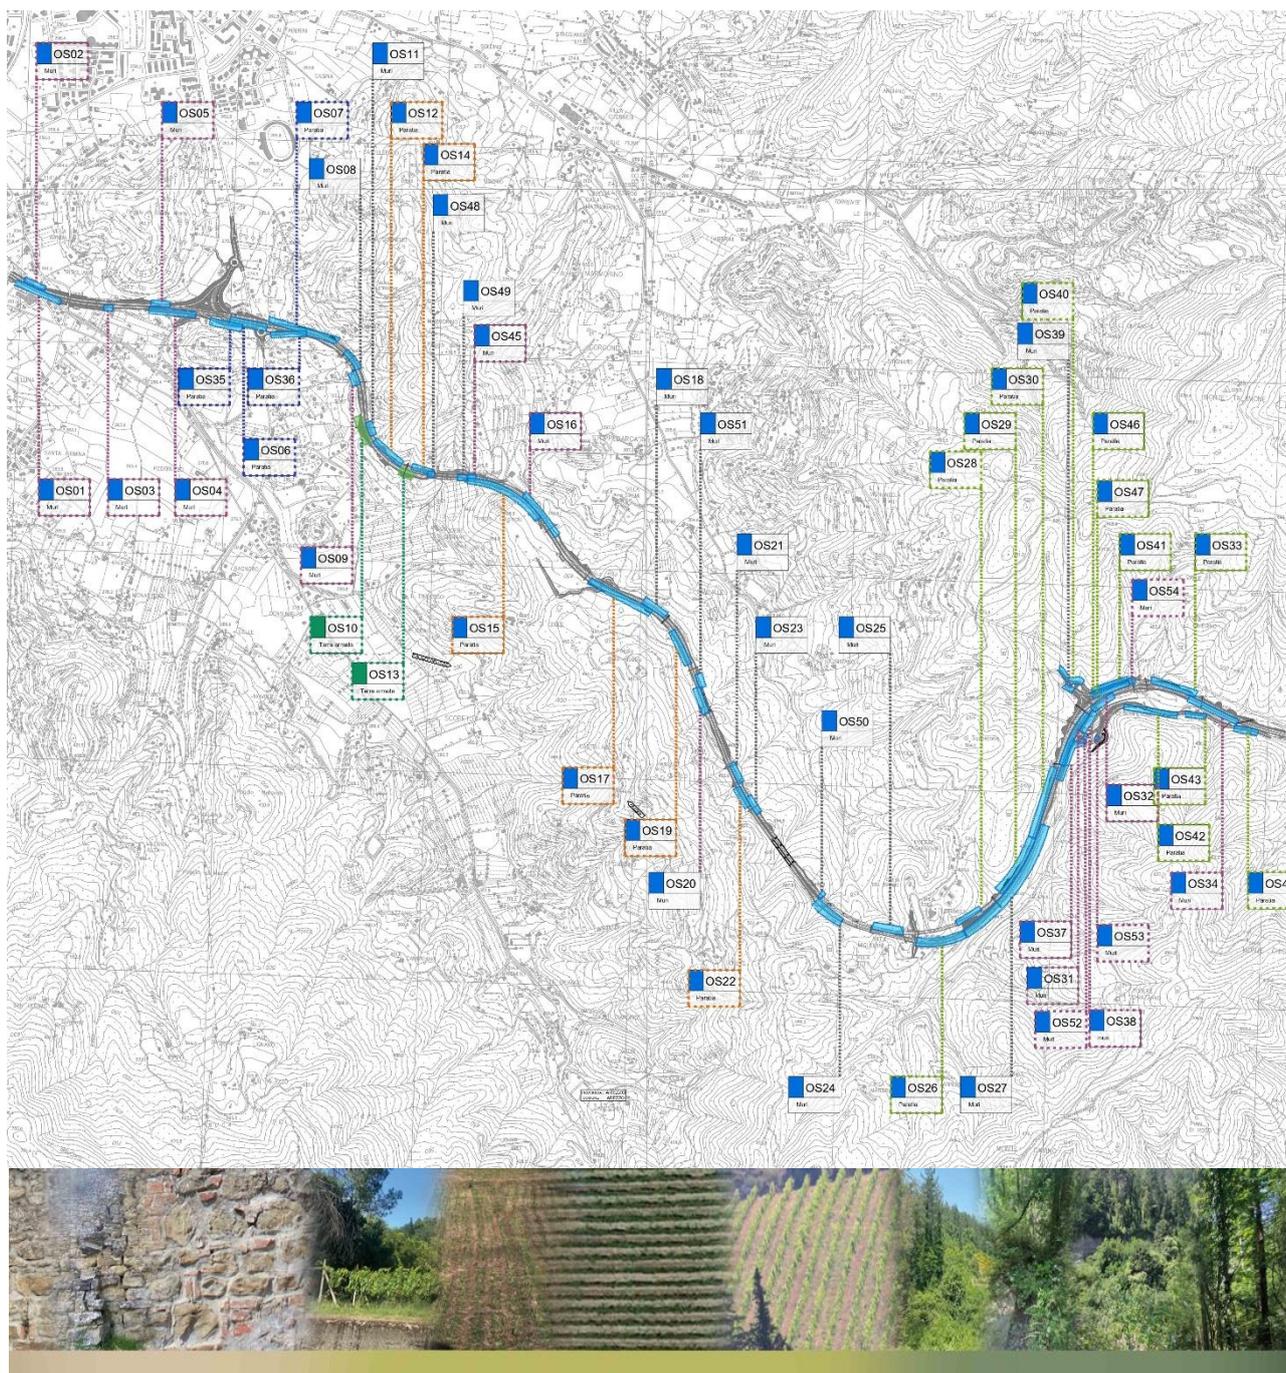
T01IA05AMBDI02 - Planimetria con l'inquadramento dei Muri e Paratie
